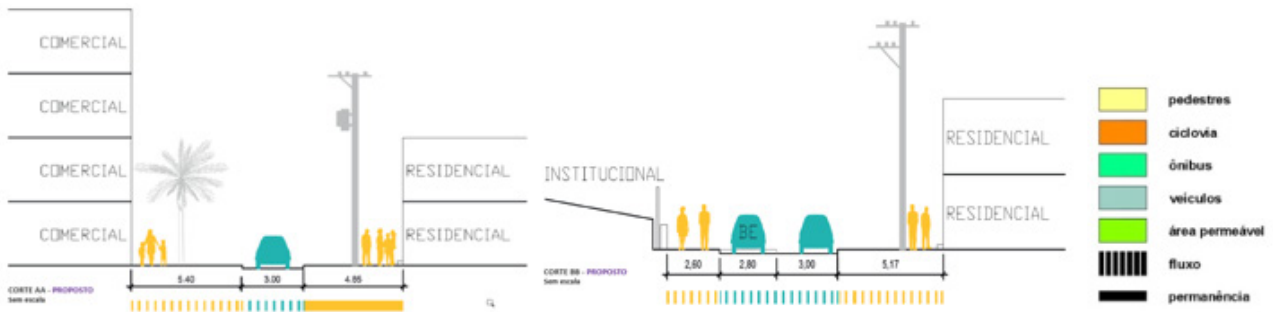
Situação após proposta de intervenção da Rua Taguá por meio de corte esquemático.
